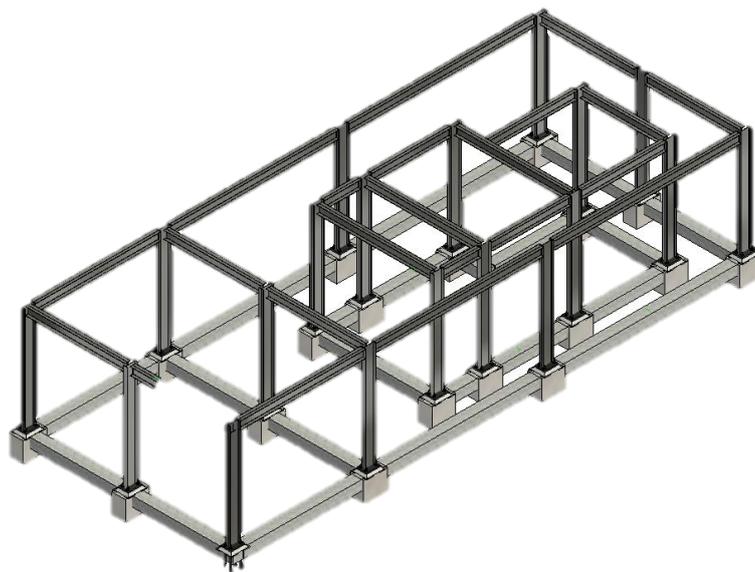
Planta 3D da proposta para pilares em estrutura metálica
